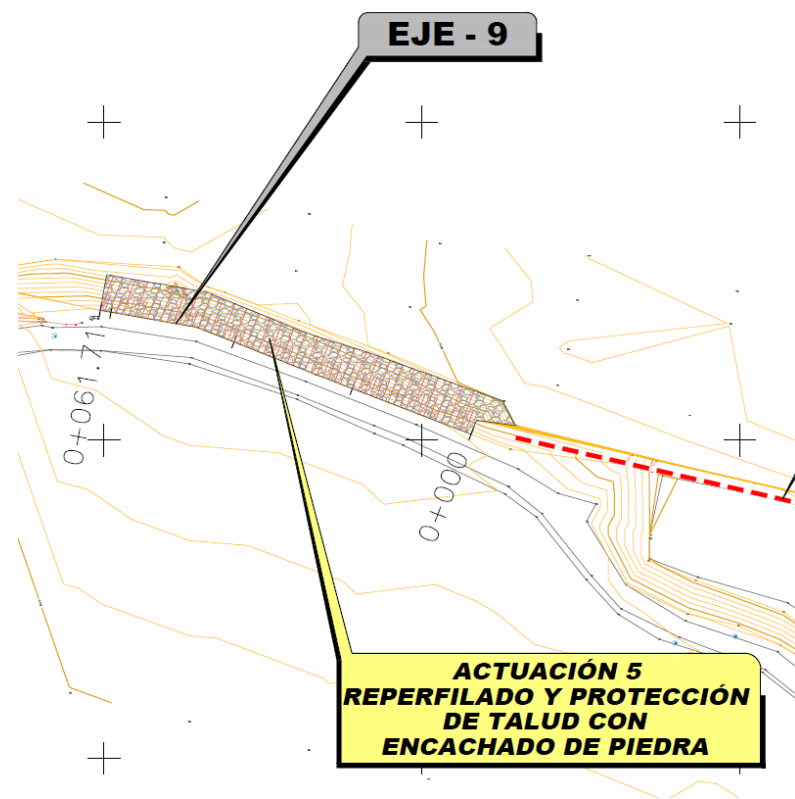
Actuación 5. Reperfilado y encachado de piedra
